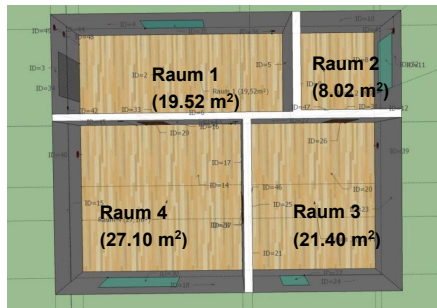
Vertikale Projektion (Grundriss) mit den Raumnummern und der Grundfläche je Raum [m²] im Google SketchUp-Modell für das Fallbeispiel Apartment
